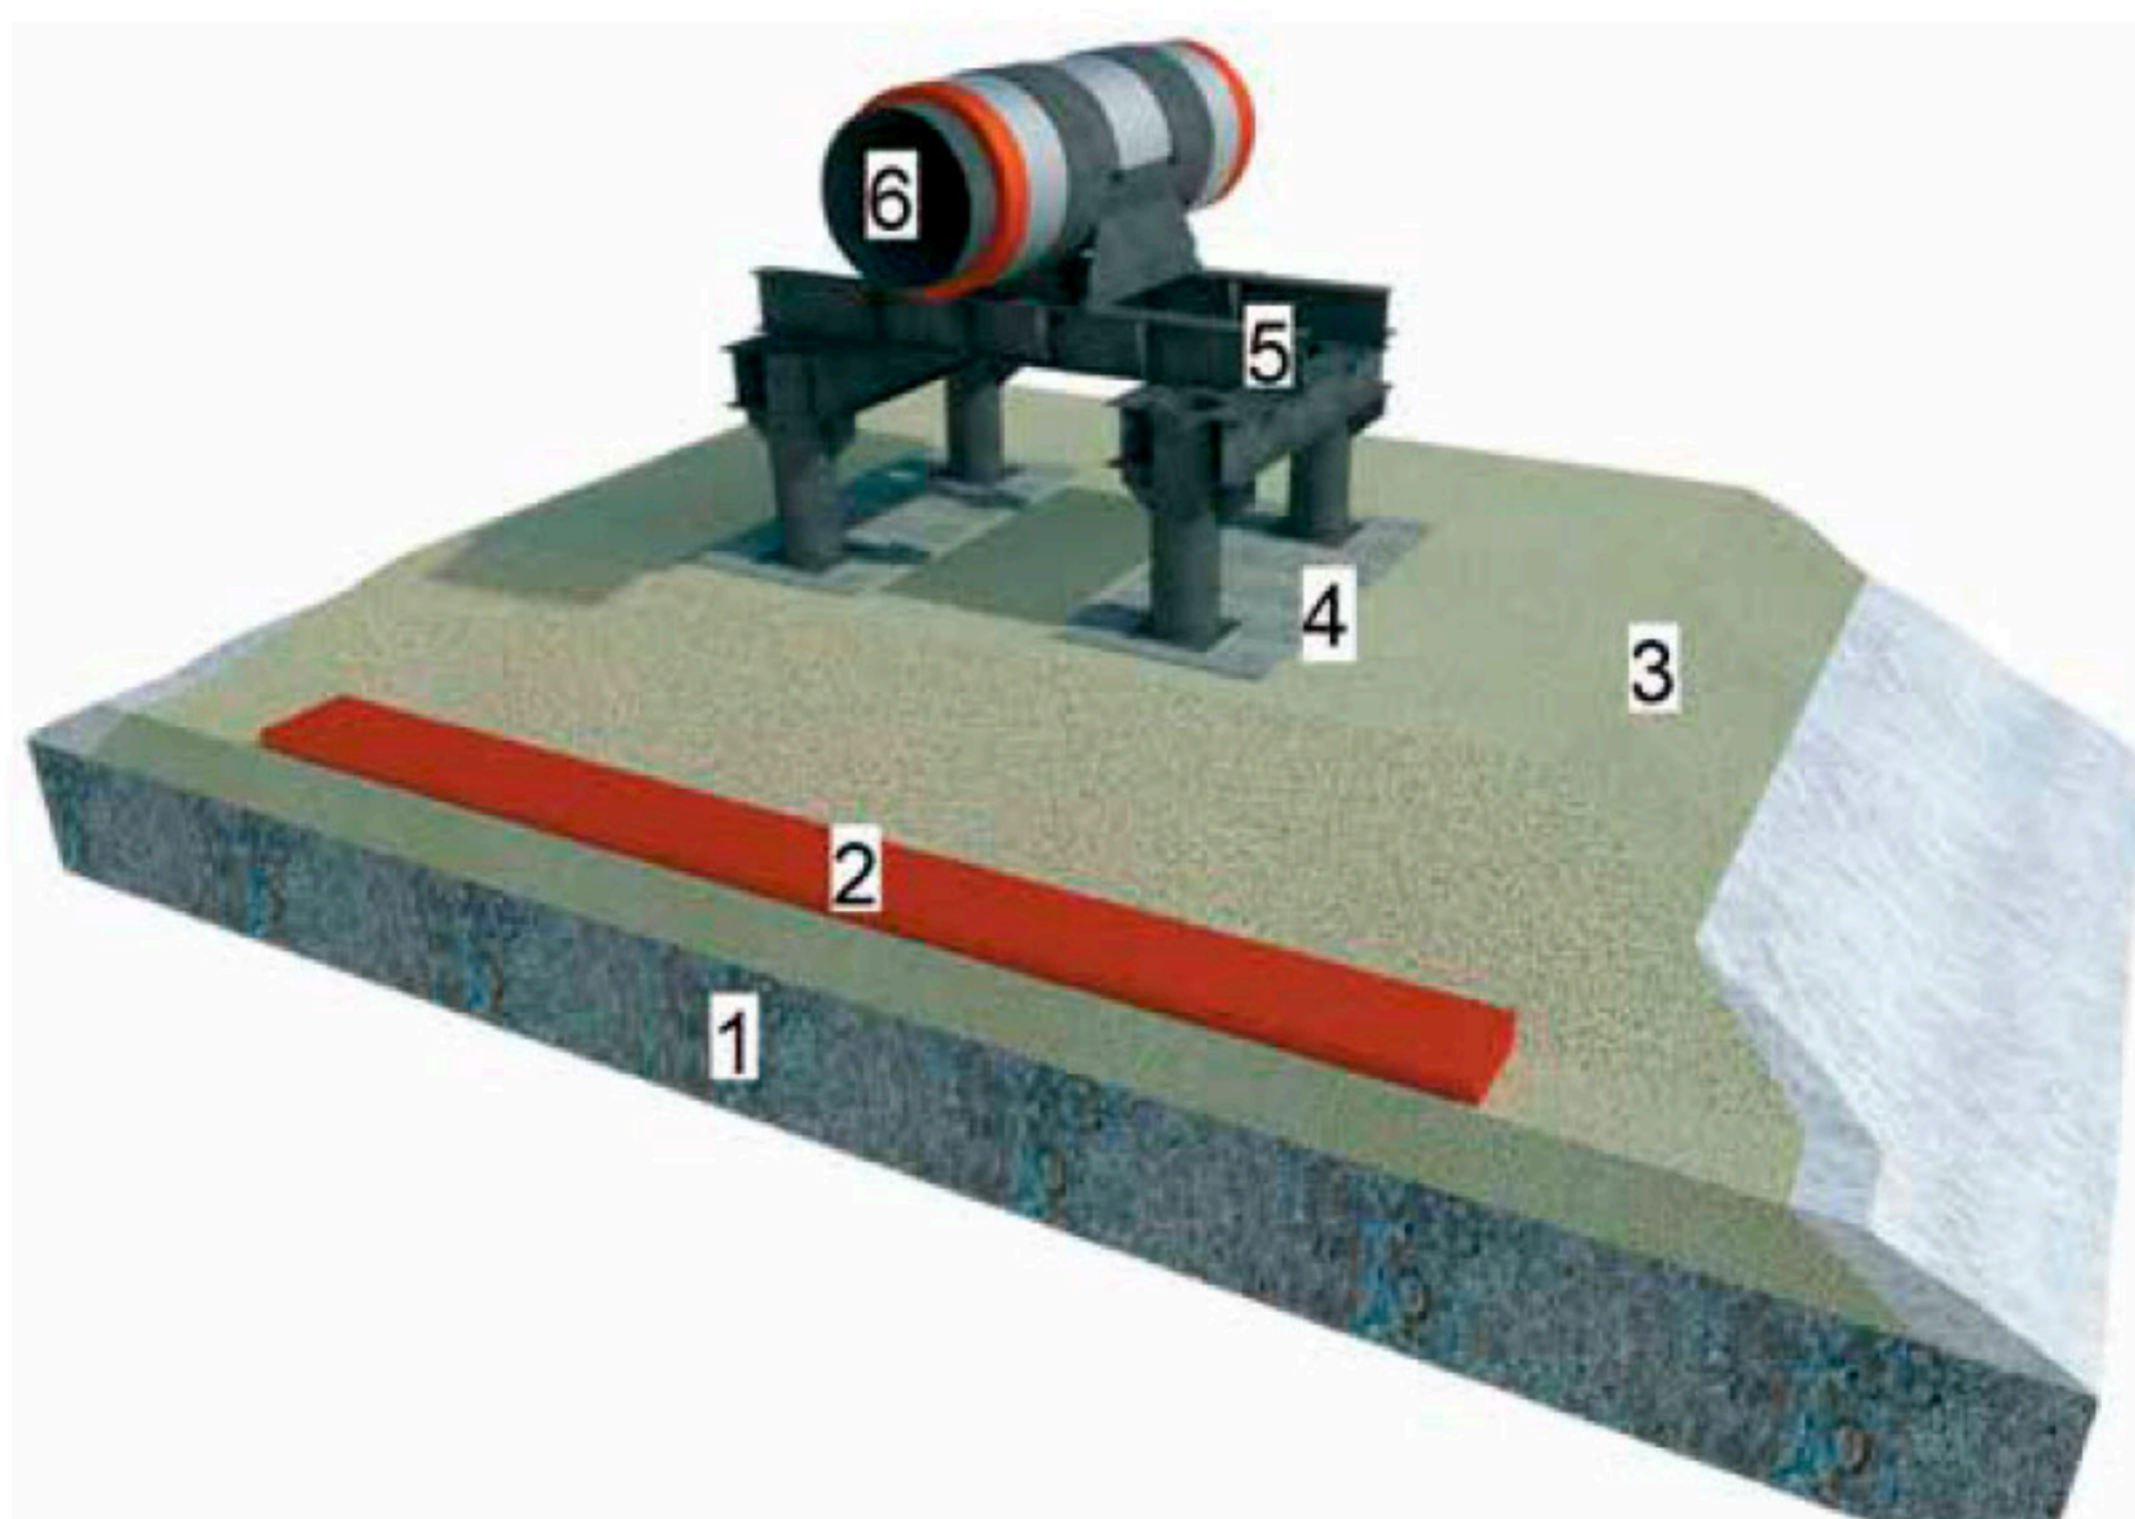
Схема обустройства теплоизоляции фундаментов опор трубопроводов на многолетнемерзлом основании с XPS
